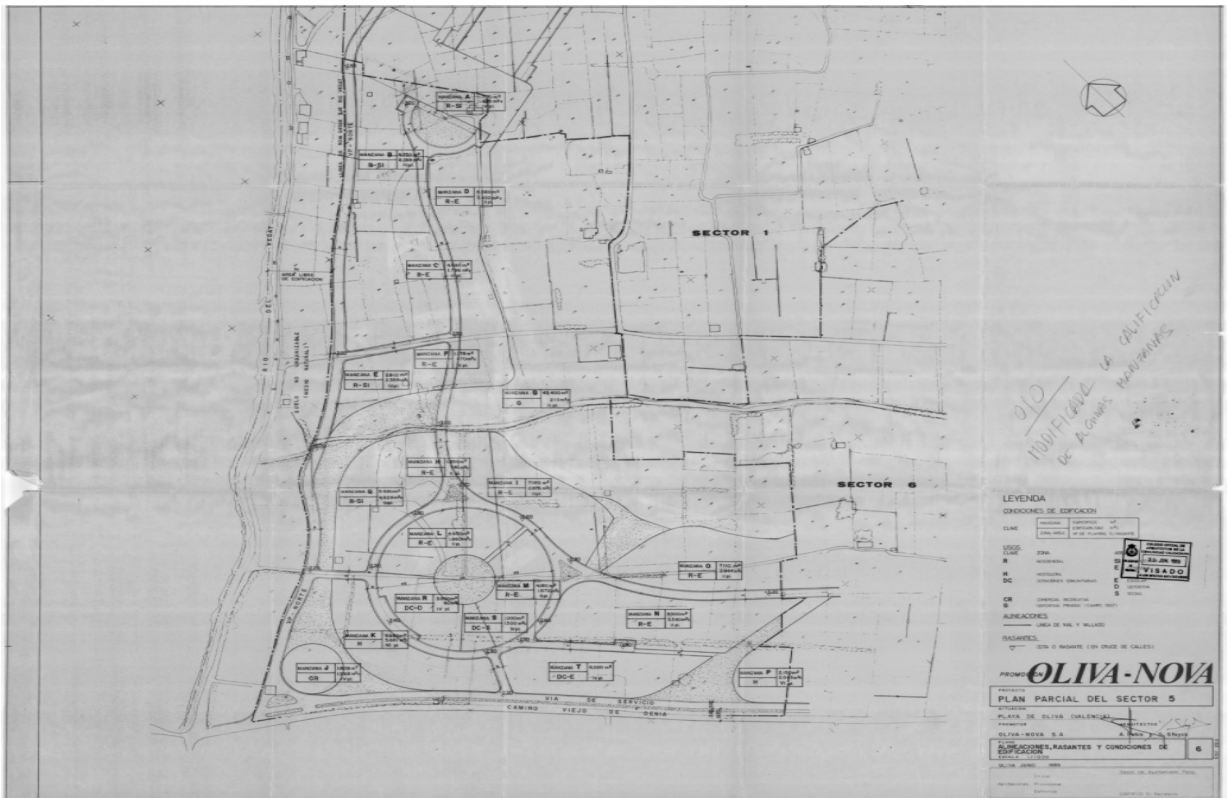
Plano Plan Parcial Sector 5 donde pueden observarse el viario y alineaciones que definen la manzana.
